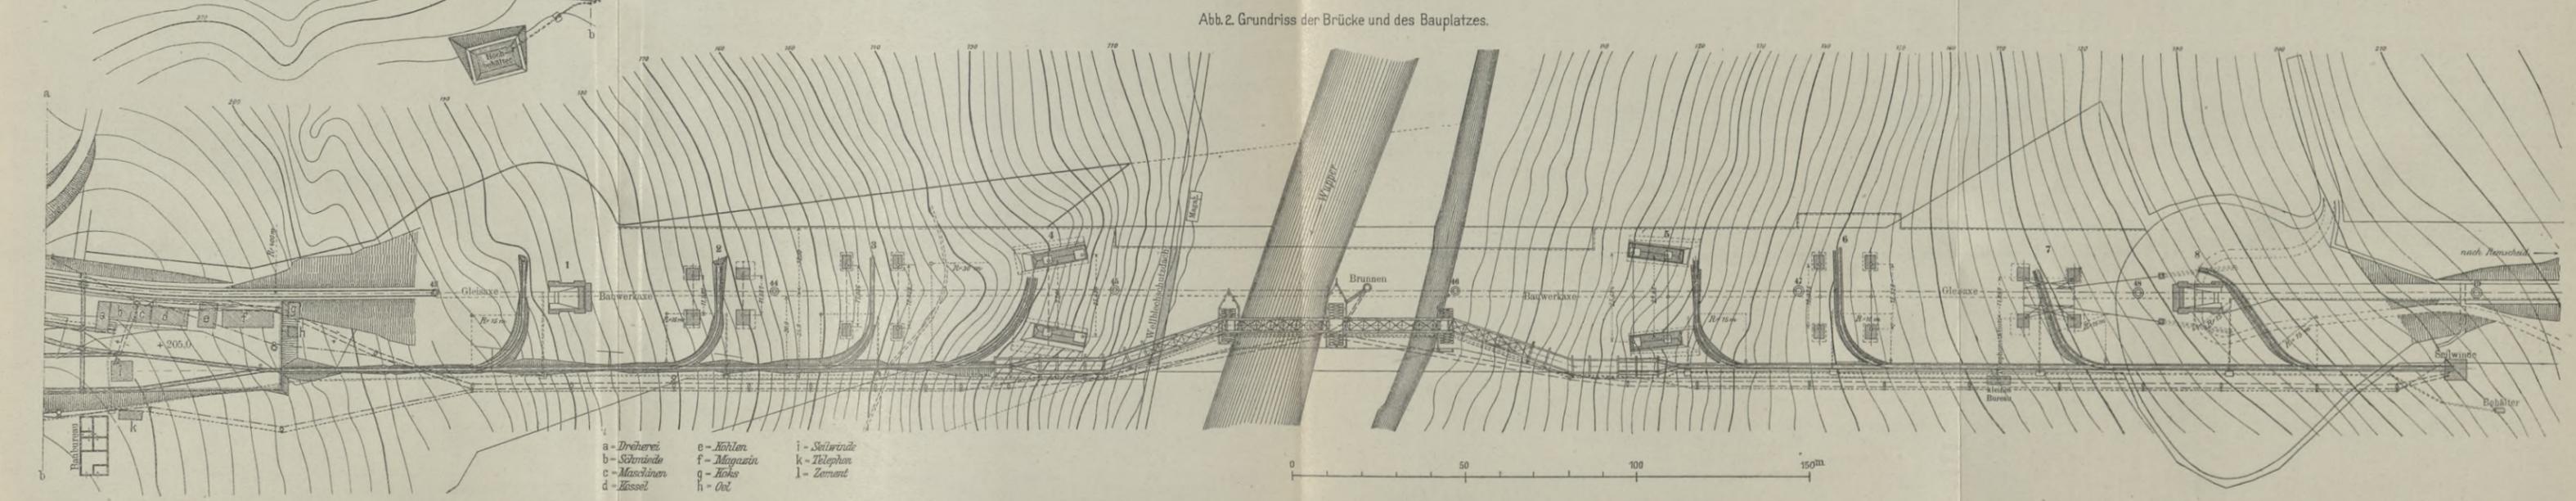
Grundriss der Brücke und des Bauplatzes.
